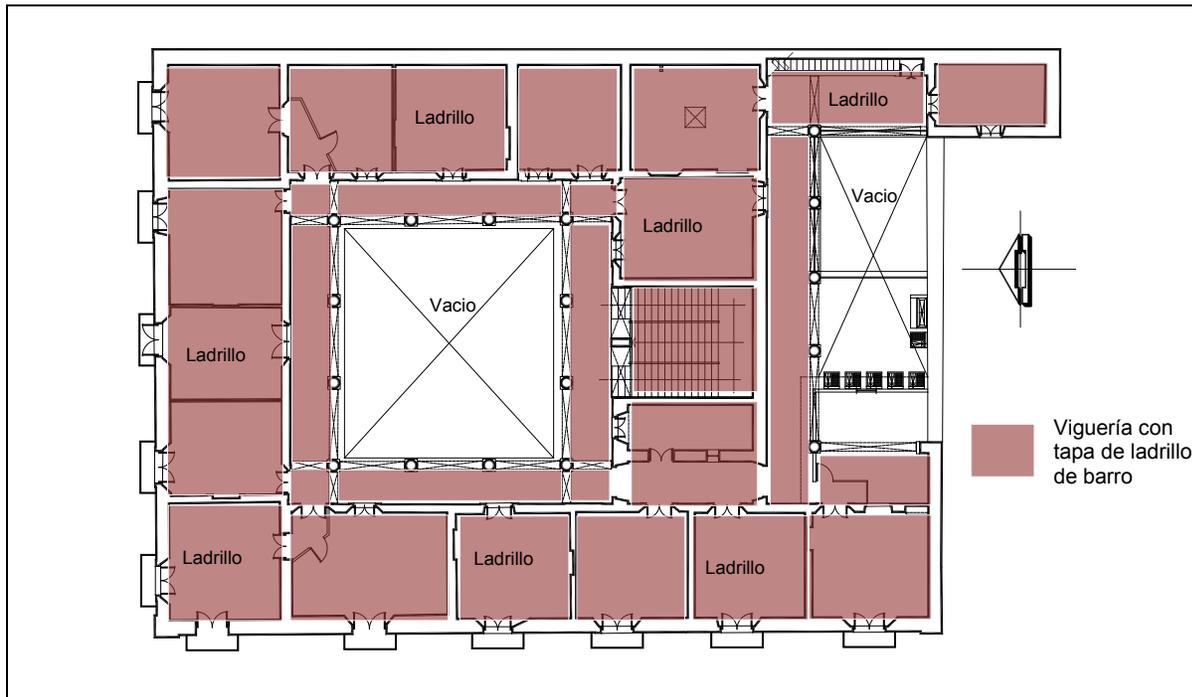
Tapas sobre viguería de madera en cubierta de casa del cura Juan Bruno de Luna, estado actual.
